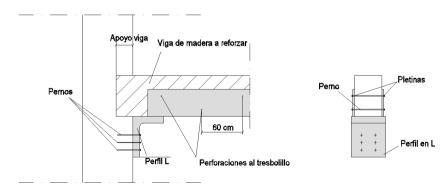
Detalle refuerzo viga cubierta. Fuente: Propia
